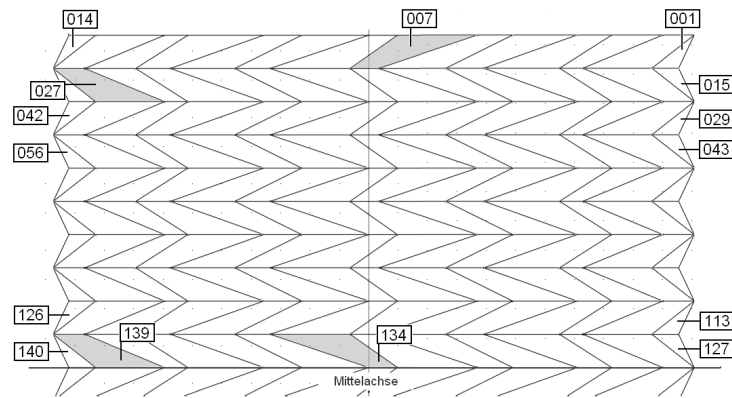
Draufsicht mit Plattenbezeichnungen
